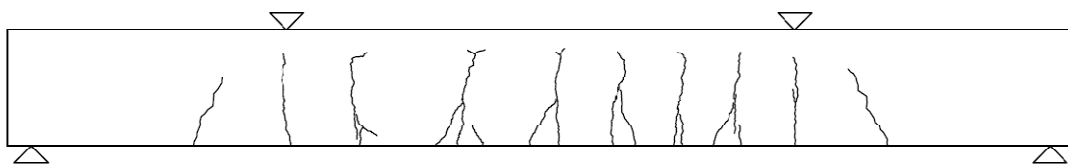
Tests a flessione, trave di riferimento: distribuzione delle fessure al collasso.
